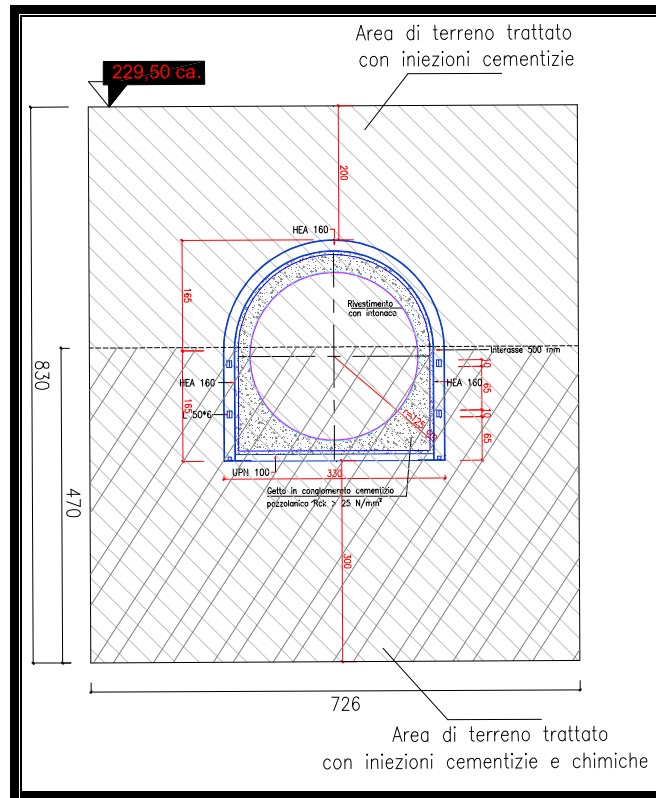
Sezione trasversale dell'area interessata dal consolidamento
